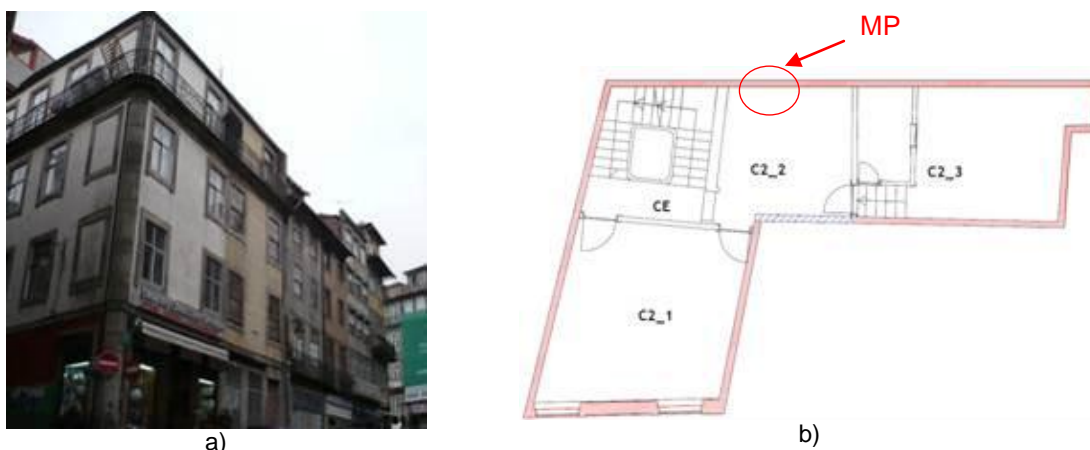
Localização do ensaio com macacos planos: a) vista do exterior do edifício; b) planta esquemática.
